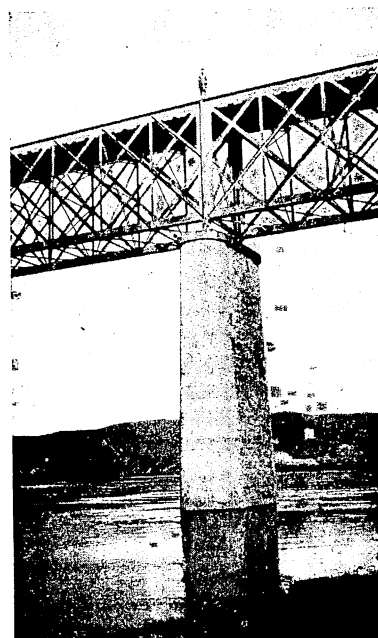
^a Una pila. (Al fondo, ruinas del puente romano y la torre de Alconétar.
